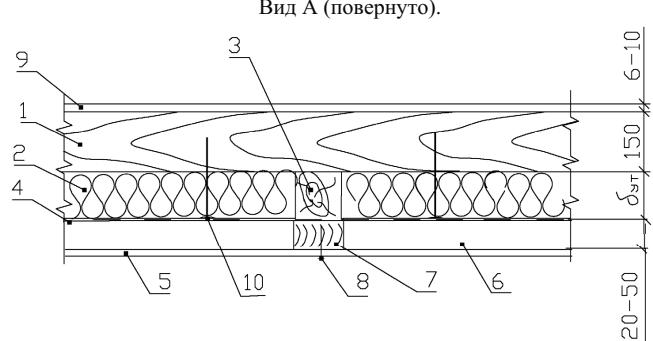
Утепление стены из бруса плитами ИЗОРОК в конструкции с вентилируемым зазором и облицовкой листовым или плитным материалом.
